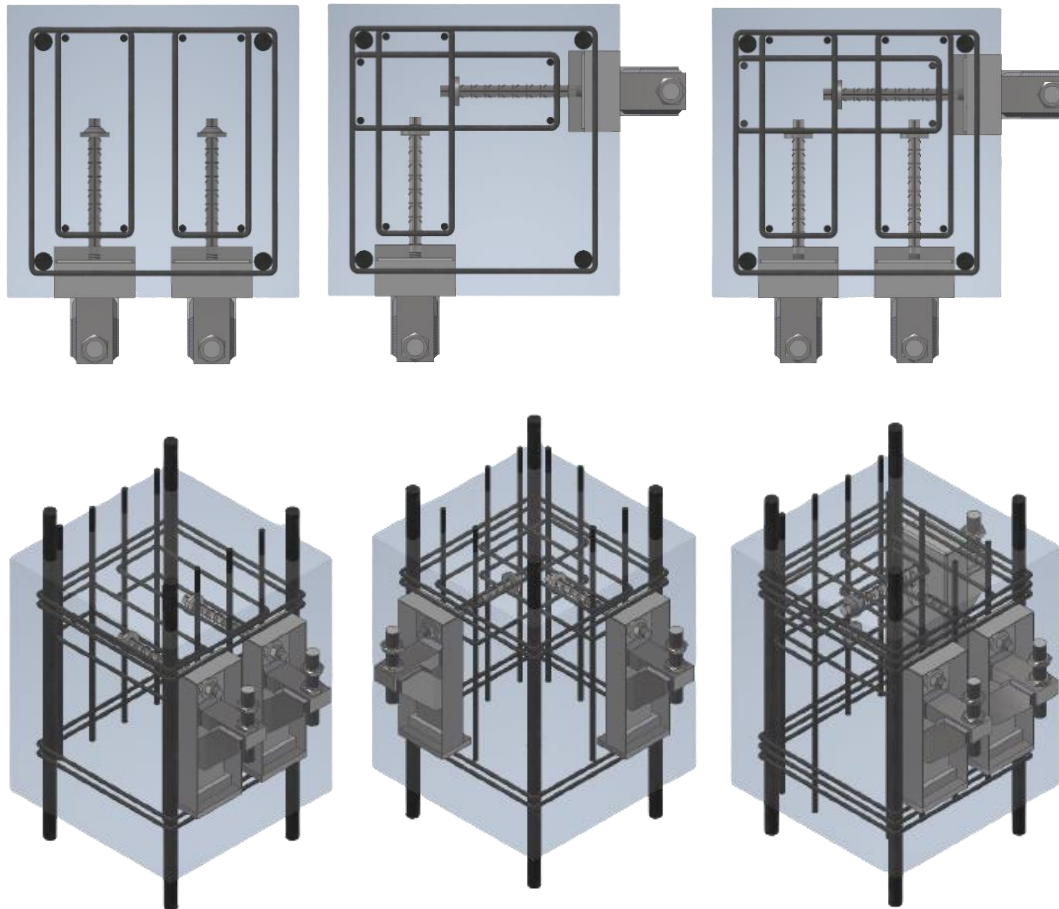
Ejemplos de disposición de la armadura adicional de los PMI en el caso de ser necesaria
